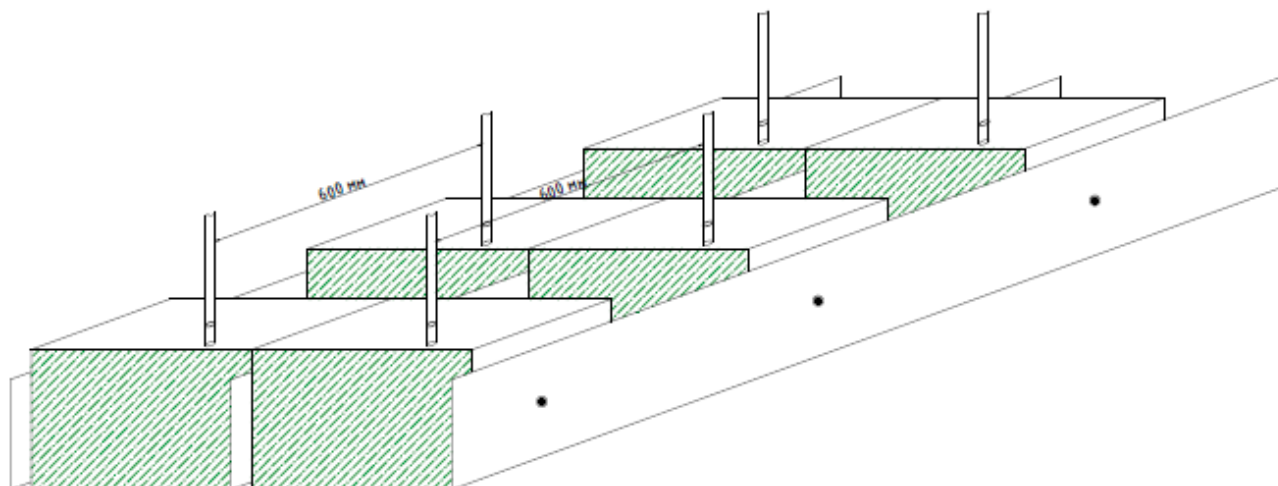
Заполнение пустот под заготовками негорючей минераловатной плитой
